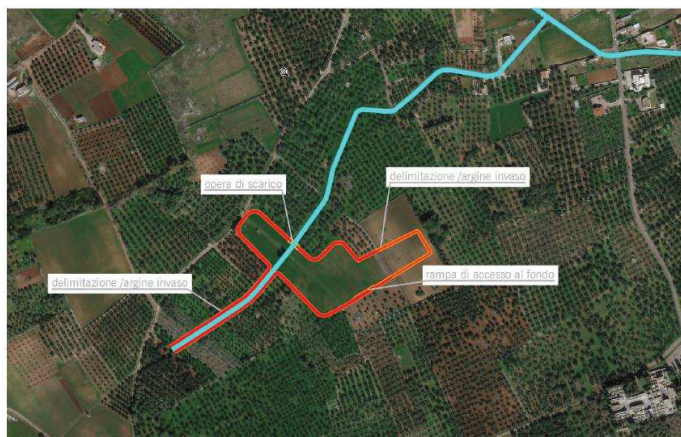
Vasca di laminazione ridotta sul Canale Tributario Destro – planimetria.
